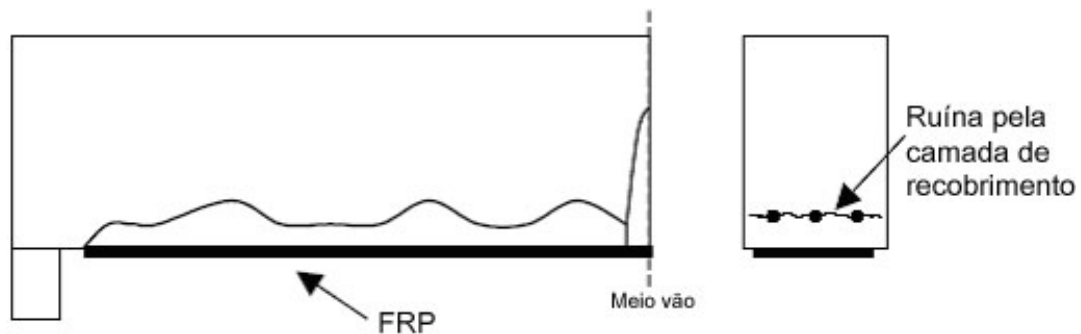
Delaminação causada por destacamento da camada de betão de recobrimento.
